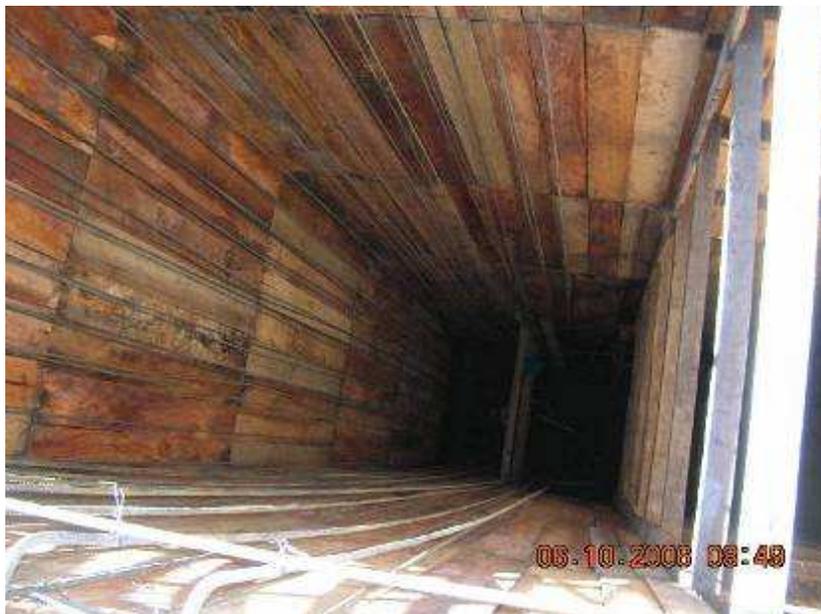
Armado de aceros de refuerzos longitudinales en pozo
